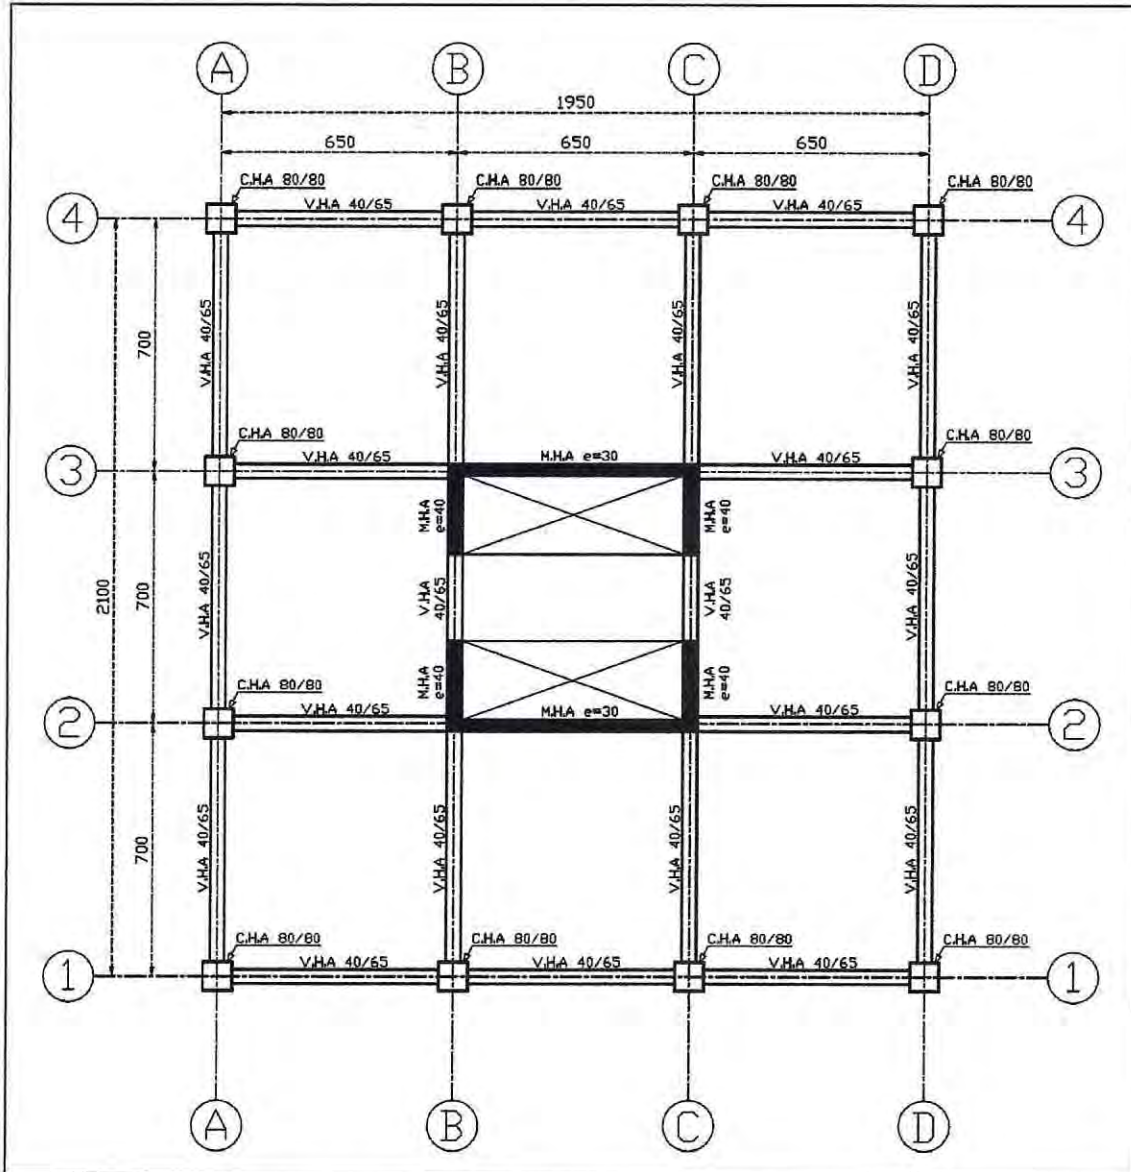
Planta tipo - Edificio con estructuración mixta.
